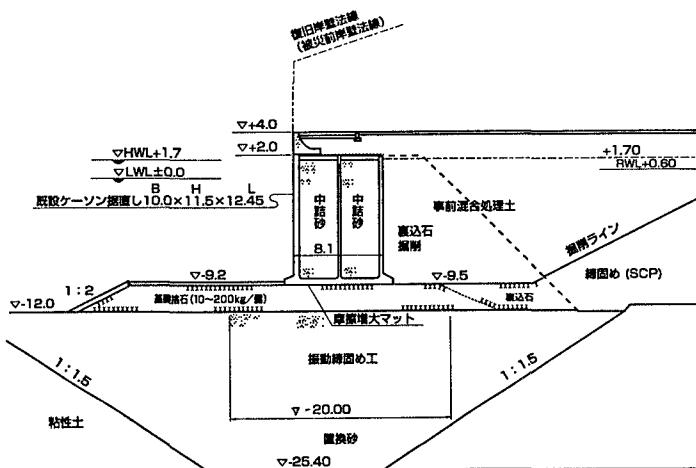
六甲アイランドフェリーバース(RF3)復旧断面図
